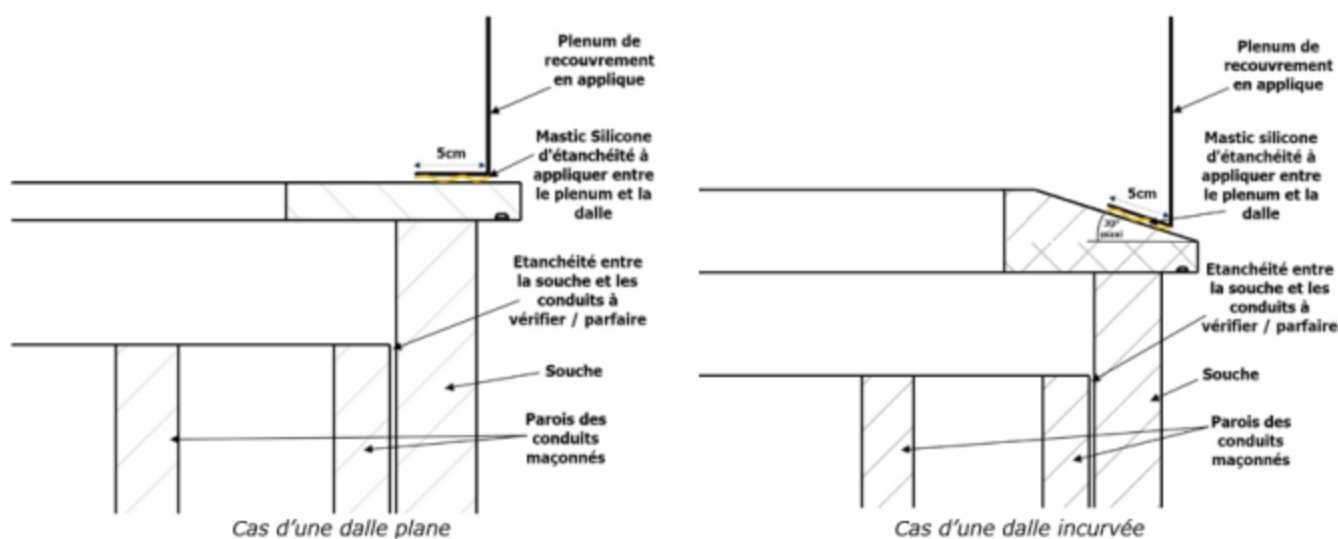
Coupes verticales d'un plénum de recouvrement en applique sur dalle conservée
